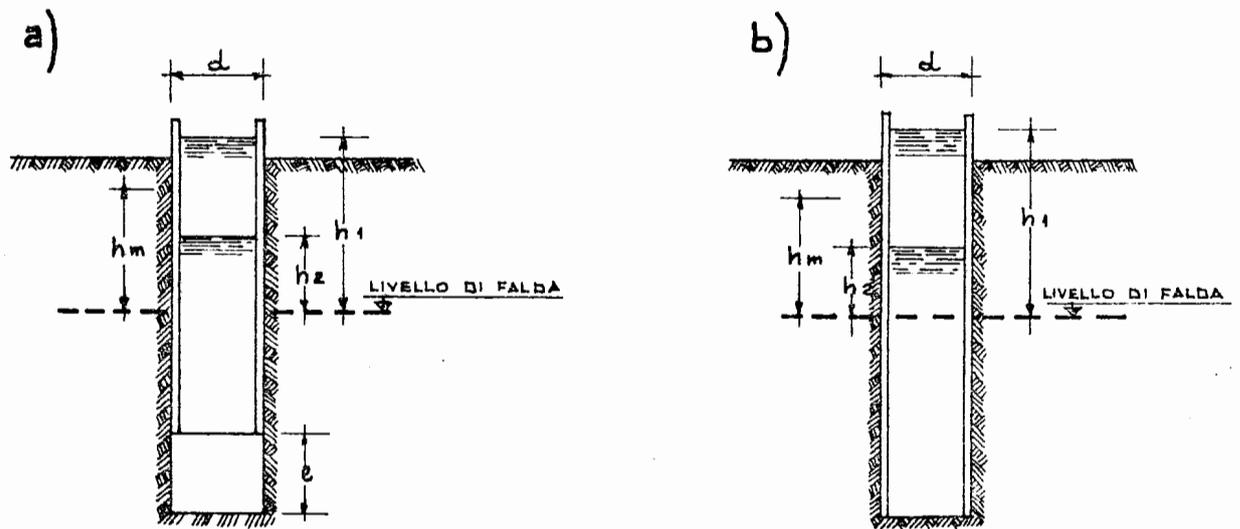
a) b) - SCHEMA DI PROVA DI IMMISSIONE IN FORI DI SONDAGGIO
